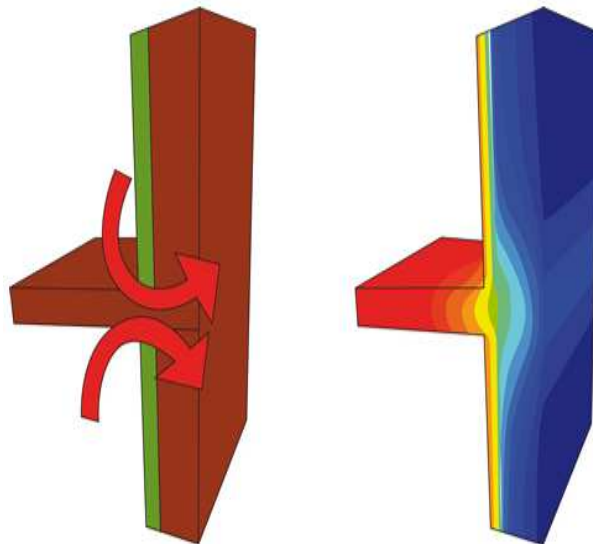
Exemple d'un pont thermique : liaison plancher intermédiaire - mur extérieur
